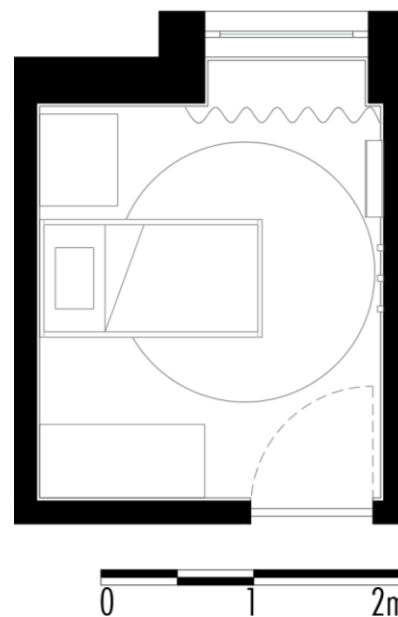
Planta proposta 2 (Fonte: Autora, 2022)
